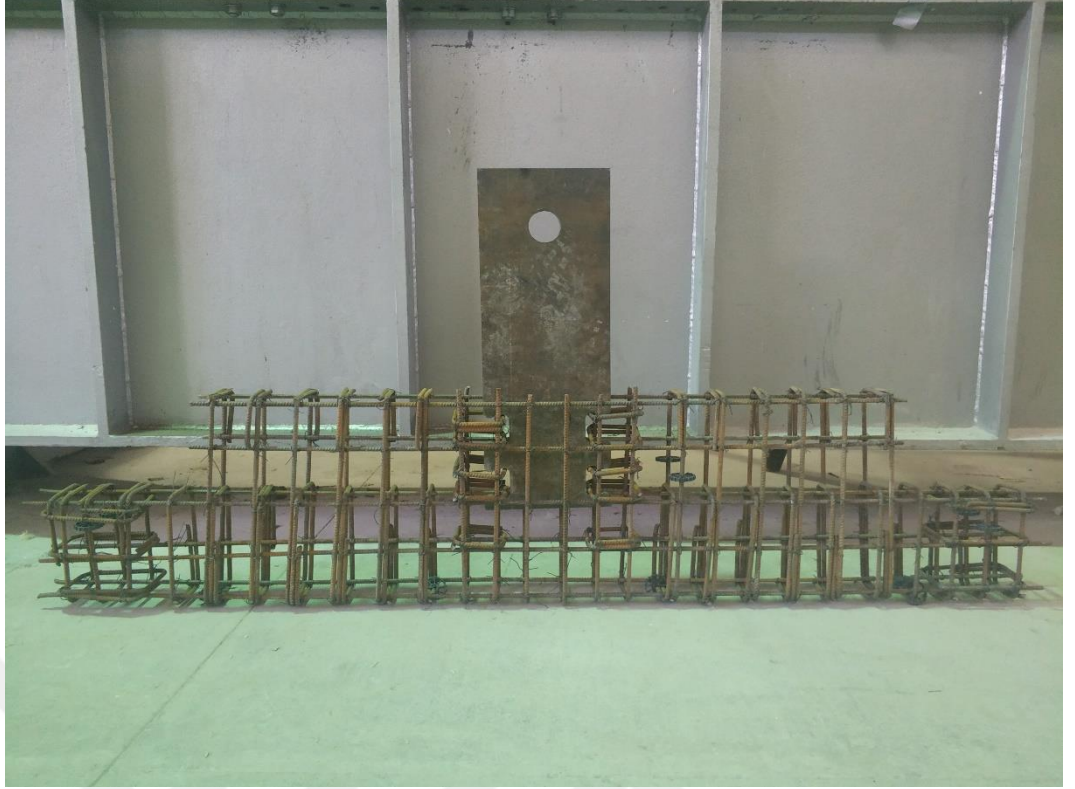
Deney Elemanı - 1 kesit A-A
